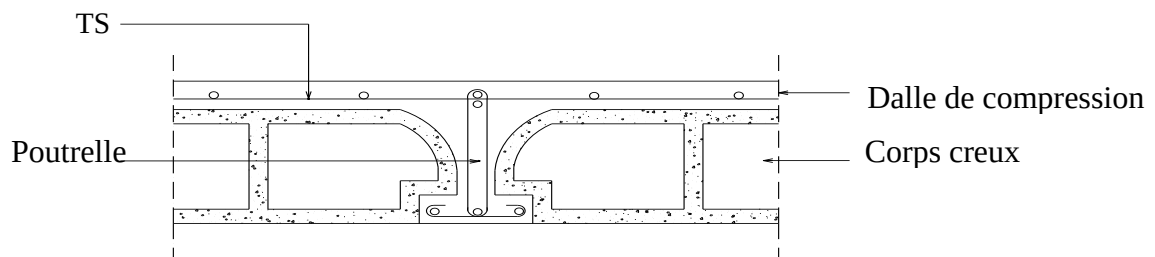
Coupe transversale d'un plancher à corps creux
